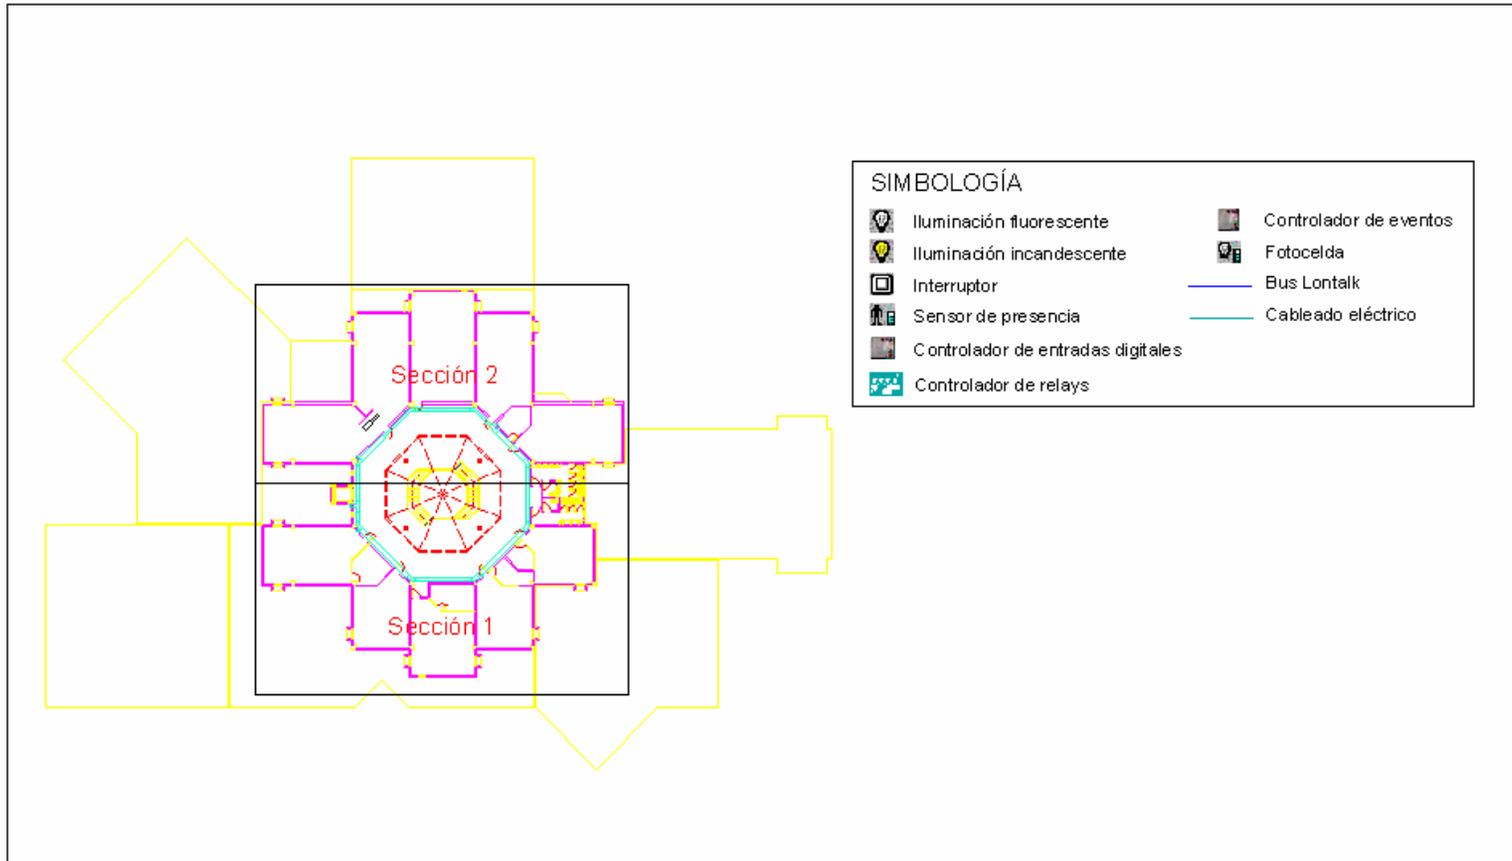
PLANO IILUMINACIÓN SEGUNDO PISO GENERAL
